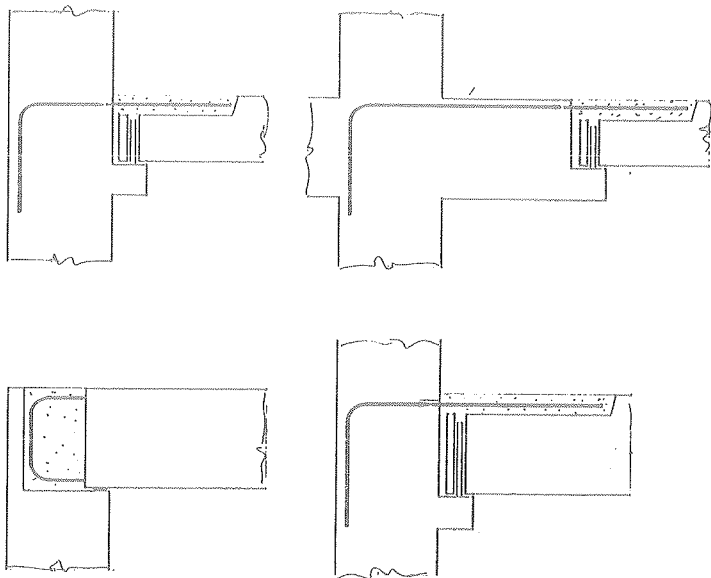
Schemi dei collegamenti rigidi dei nodi trave-pilastro.
